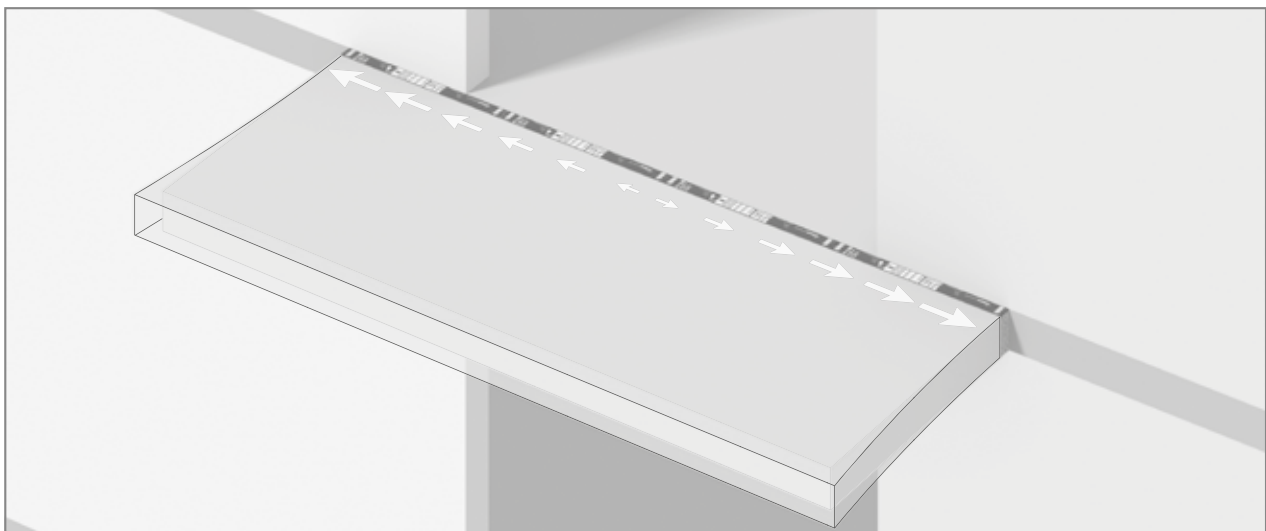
dilatazione della soletta del balcone dovuta a riscaldamento e sollecitazione di Schöck Isokorb®
